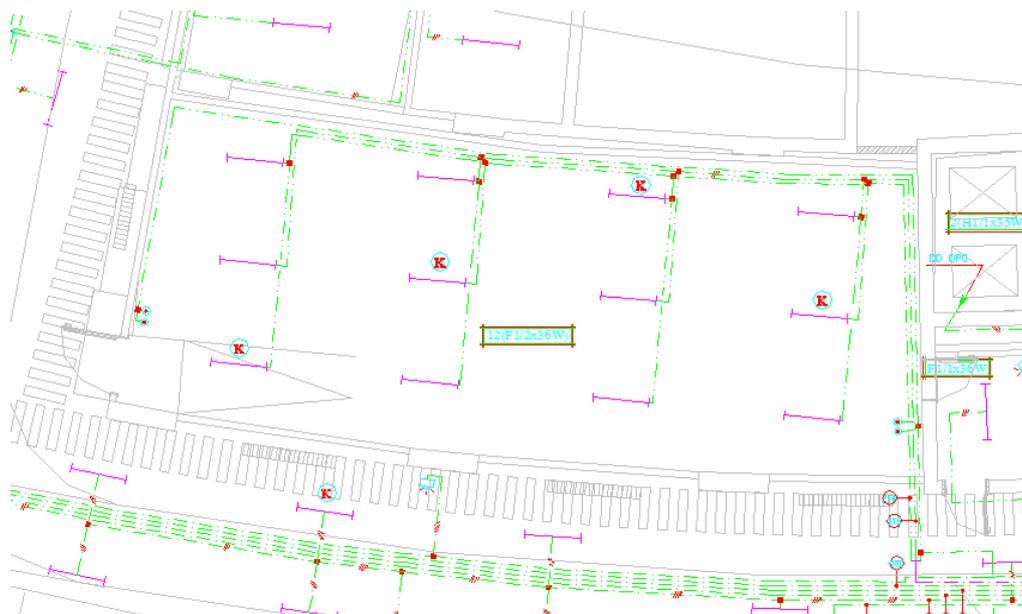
Planta da sala de arquivo do edifício em estudo
